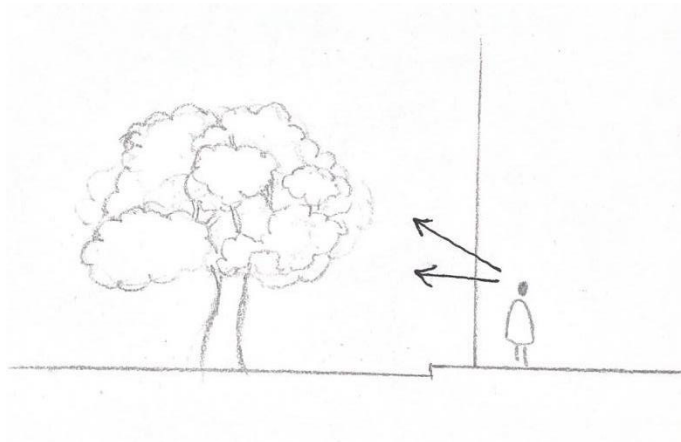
Vista a la integración de exterior con espacio arquitectónico. Elaboración: propia.
